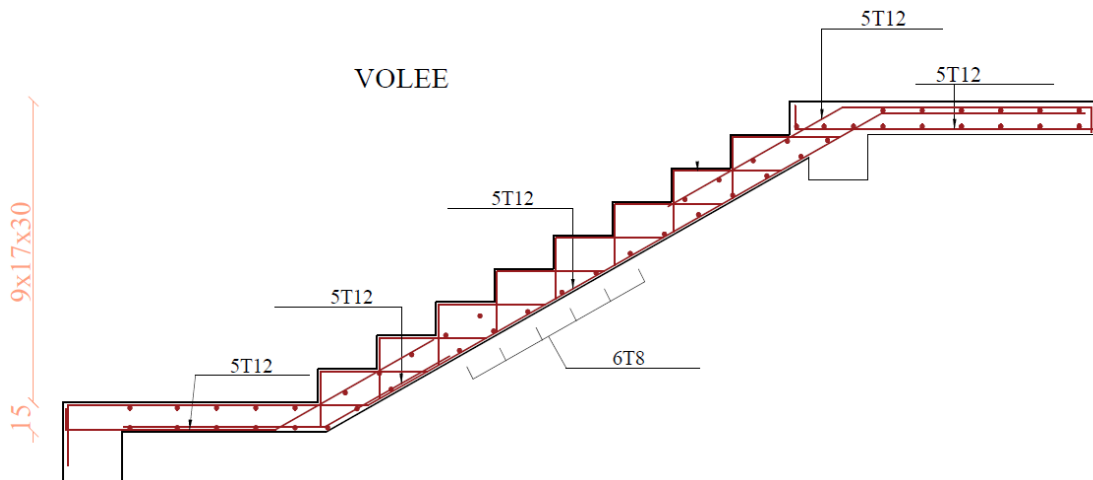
Schéma de ferrailage du 5^{ème} Type d'escalier.
